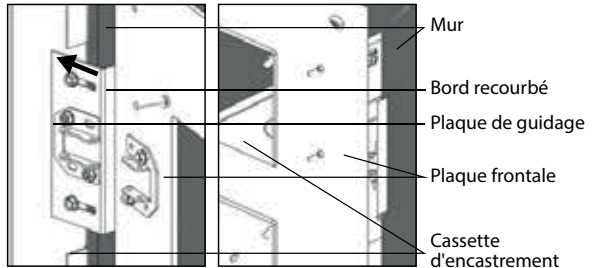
Aligner les plaques de guidage Fig. 8 : Aligner sur le plâtrage du mur
